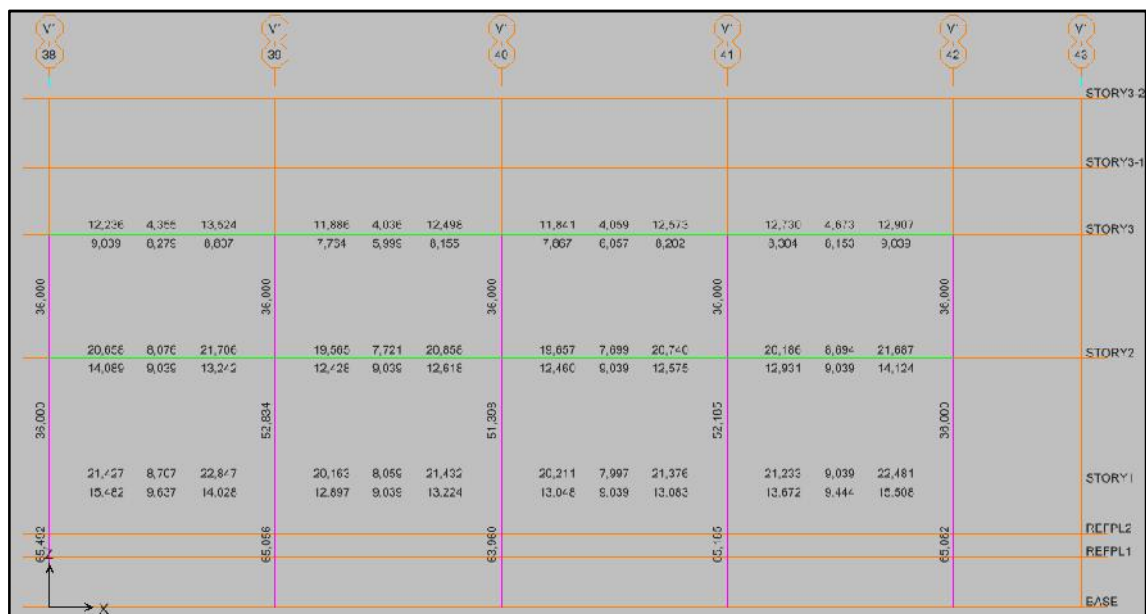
Acero en vigas pórtico V, Consulta Externa II
